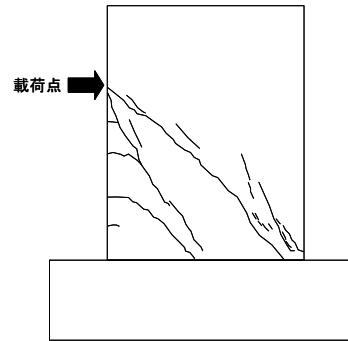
ひび割れ分布 No. 13 (ひび割れが集中する場合)
